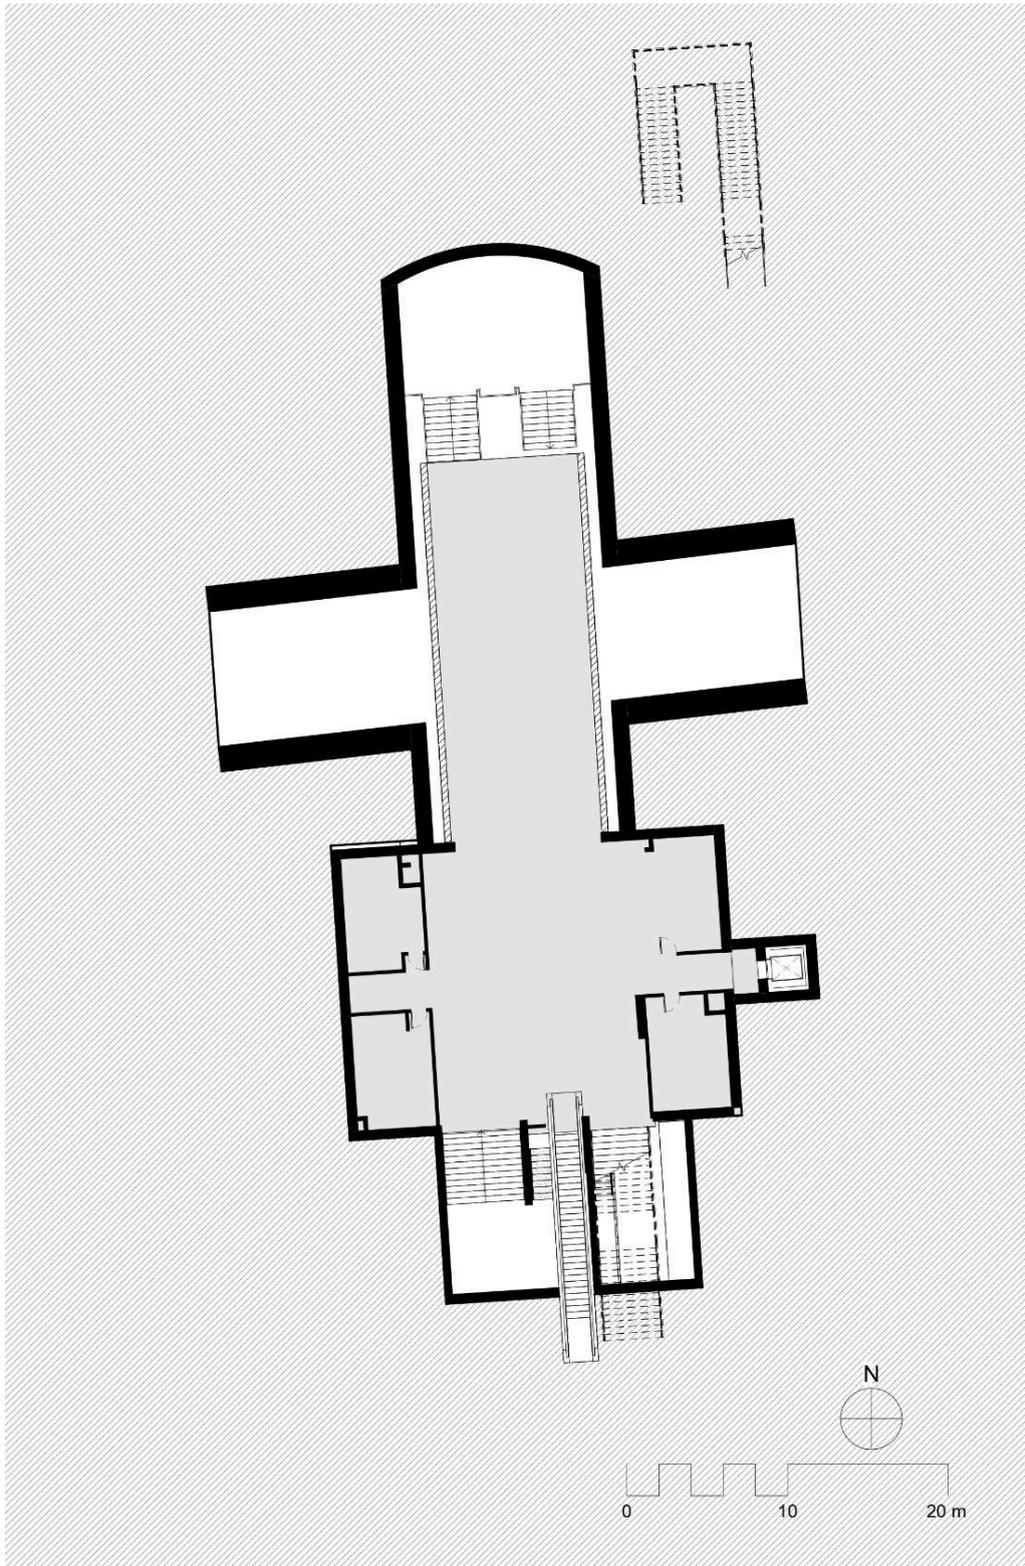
Planta nivel -3. Fuente: Elaboración propia.
